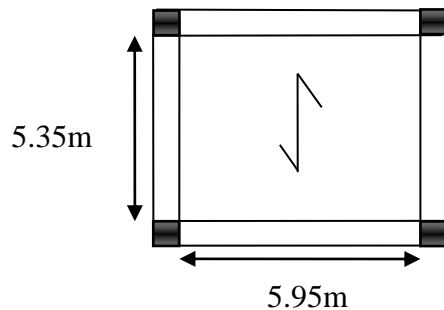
Sens de la disposition des poutrelles de la terrasse inaccessible
